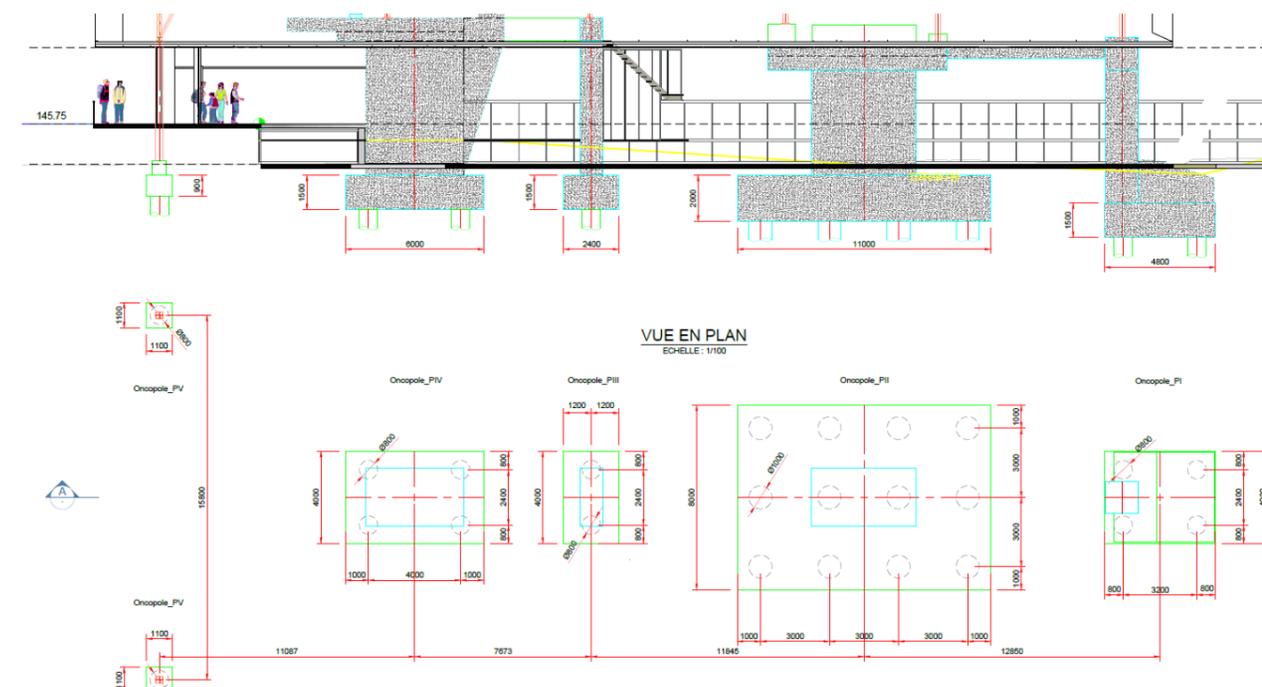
Fondations de la station Oncopole (source : Groupement POMA, 2018)
